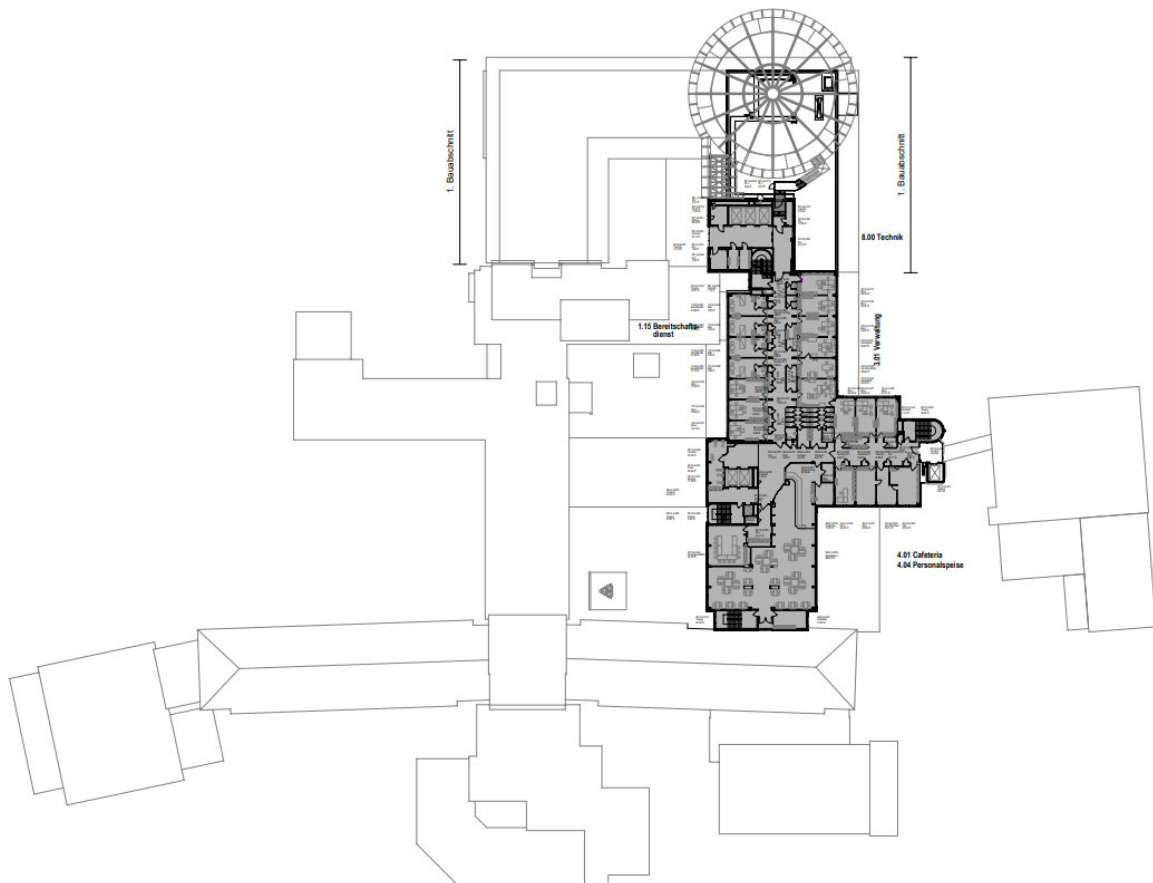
Grundriss 6. Obergeschoss mit Brandschutzmängeln (grau)
